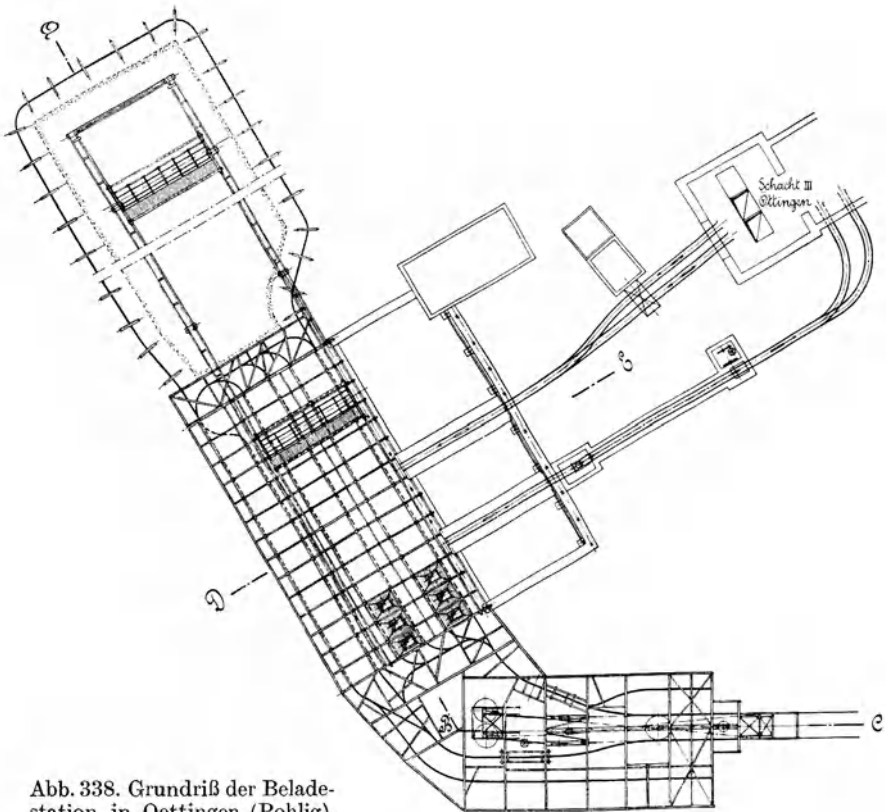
Grundriß der Beladestation in Oettingen (Pohlig).
